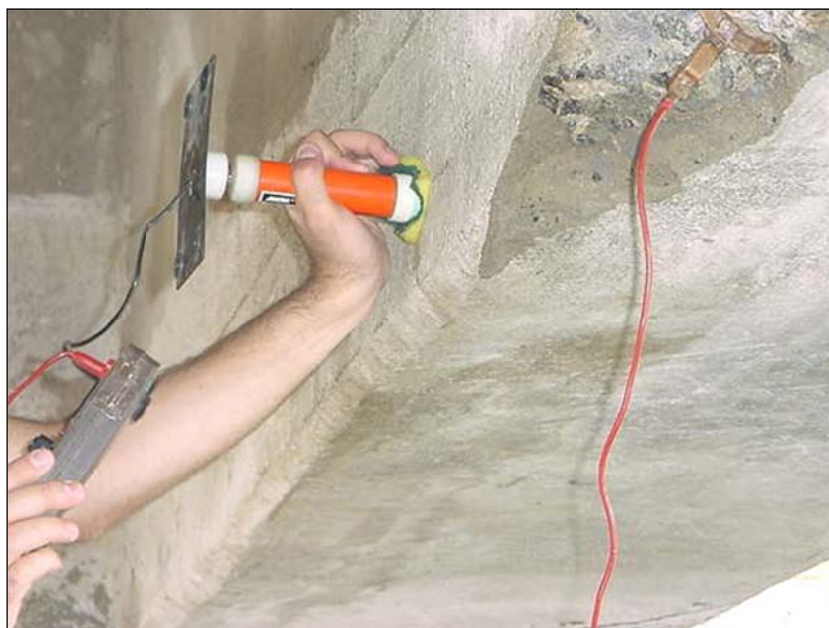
Ensaio de potencial de corrosão das armaduras no concreto.
